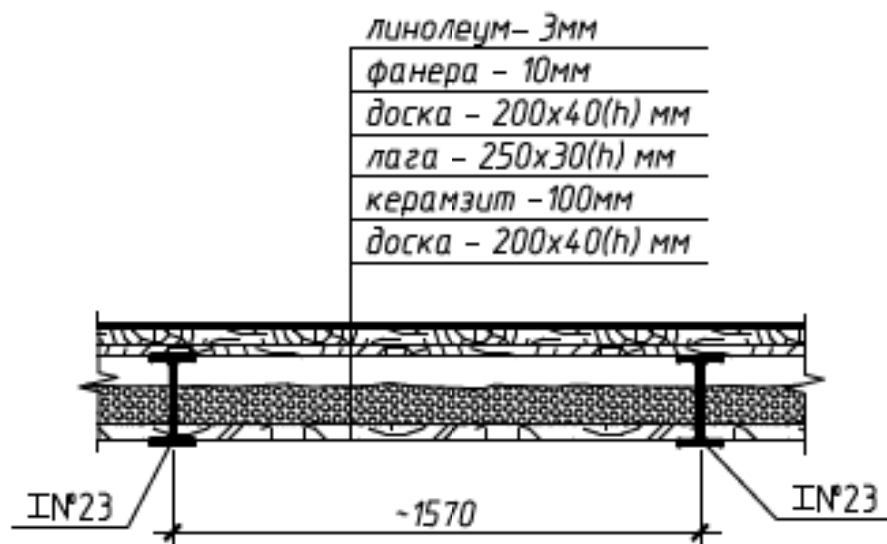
Вскрытие 3 (пол 4-й этаж)
